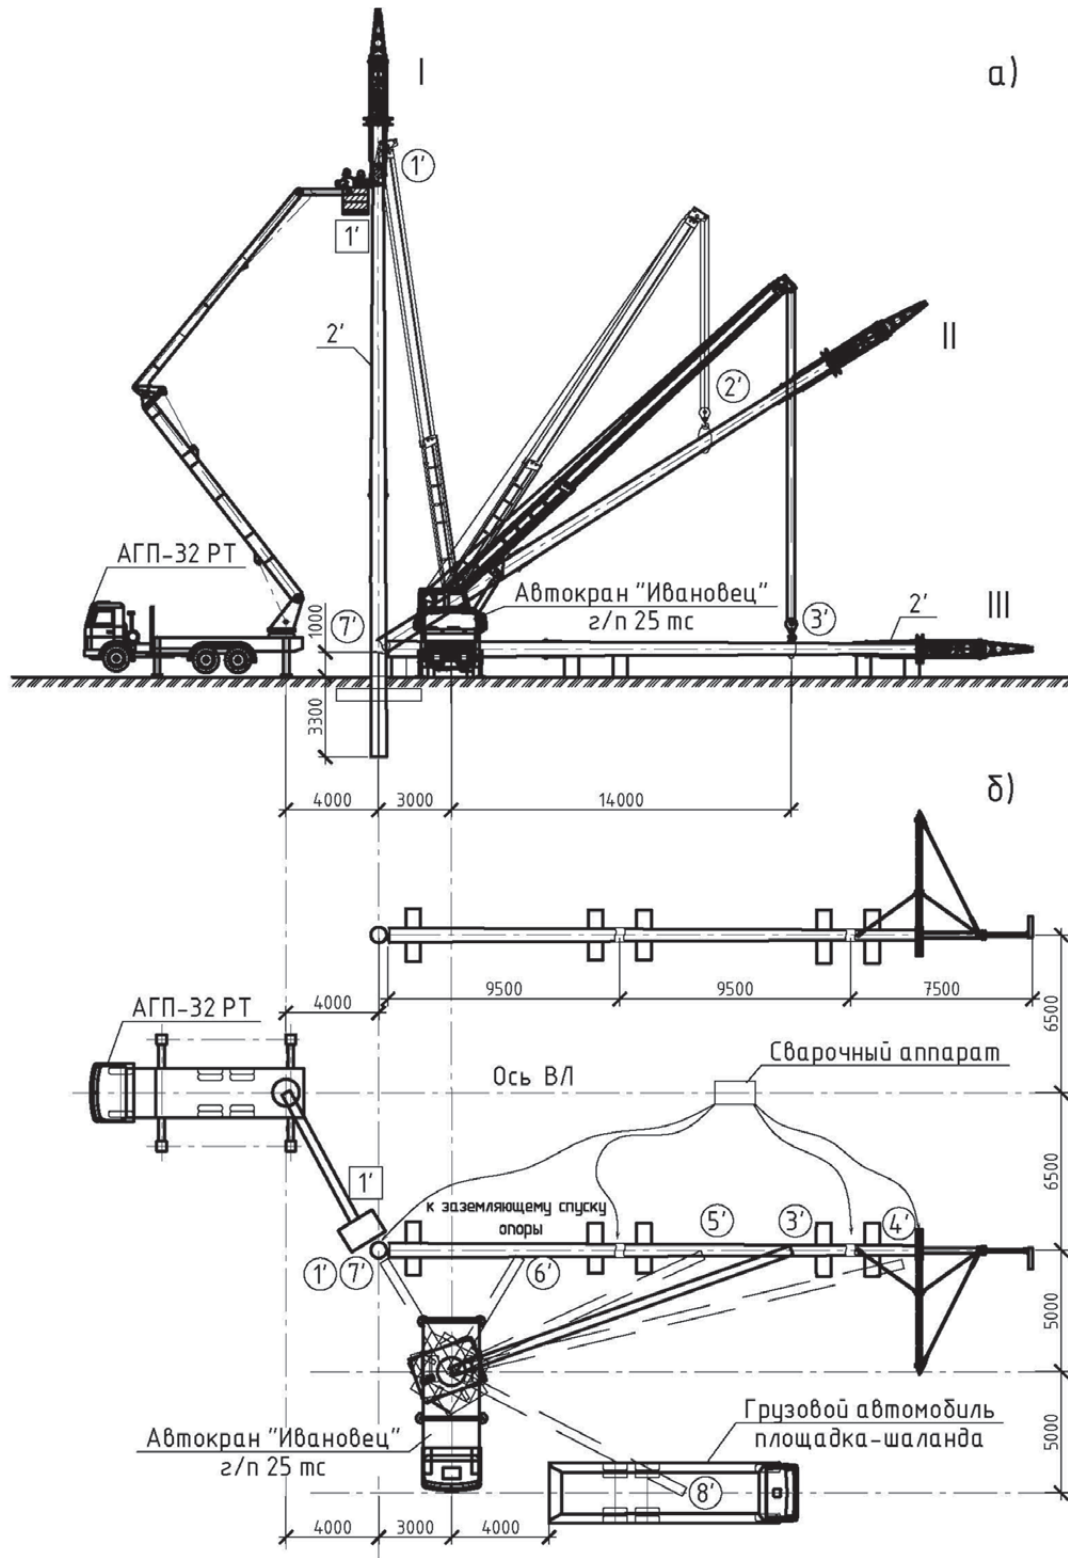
Схема демонтажа, разборки и погрузки на автотранспорт железобетонных стоек и металлоконструкций старой опоры ПБ500-5н
